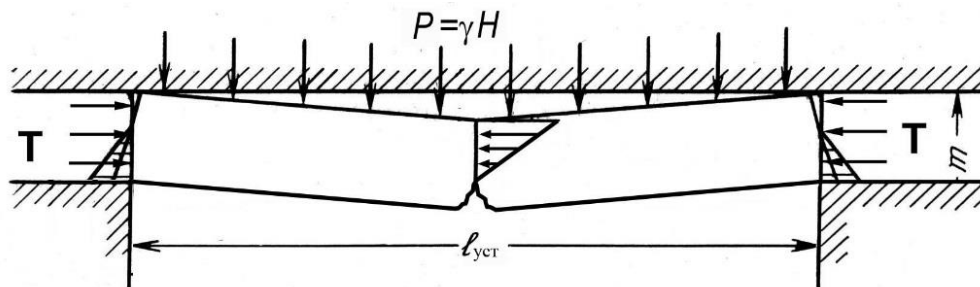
Схема к расчету устойчивого пролета кровли между внутриблоковыми целиками
